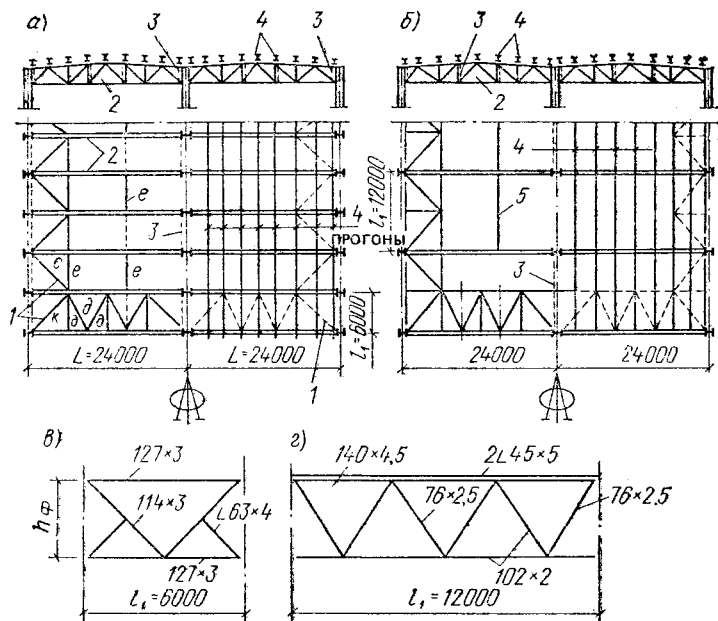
Компоновка связей в покрытиях по трубчатым стропильным фермам пролетом 24 м (по проекту ЦНИИПроектстальконструкции им. Мельникова)
